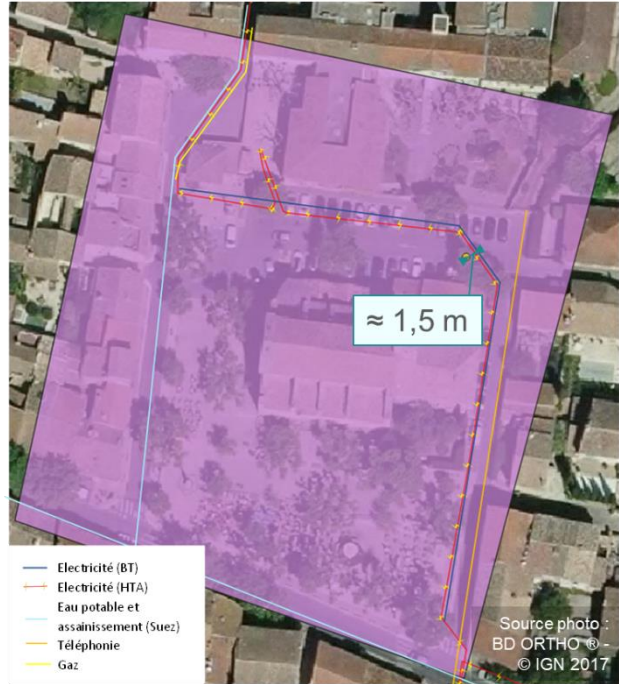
Maussane-les-Alpilles (option 1) – Parking Charles Piquet – Synthèse des réseaux
